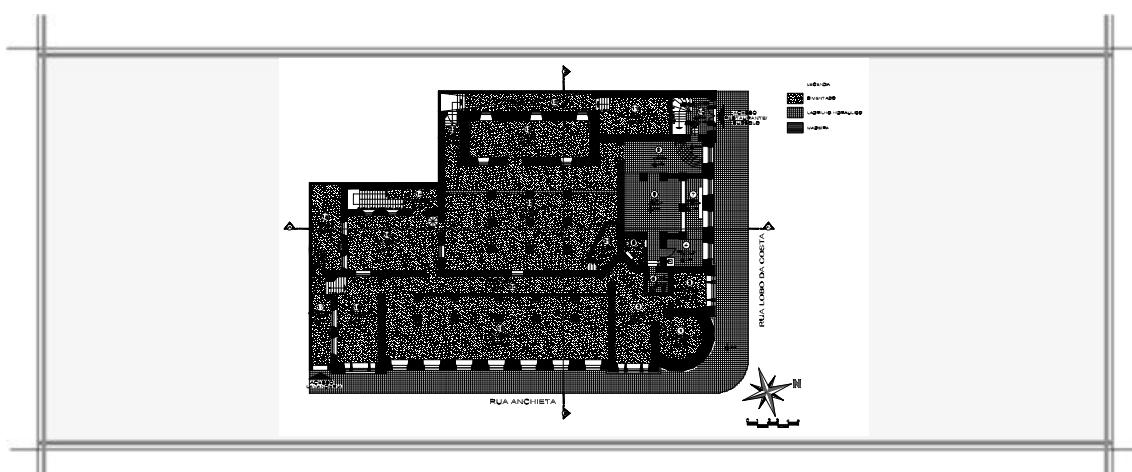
Planta Baixa do Subsolo. Desenho: Cristiane Müller.
